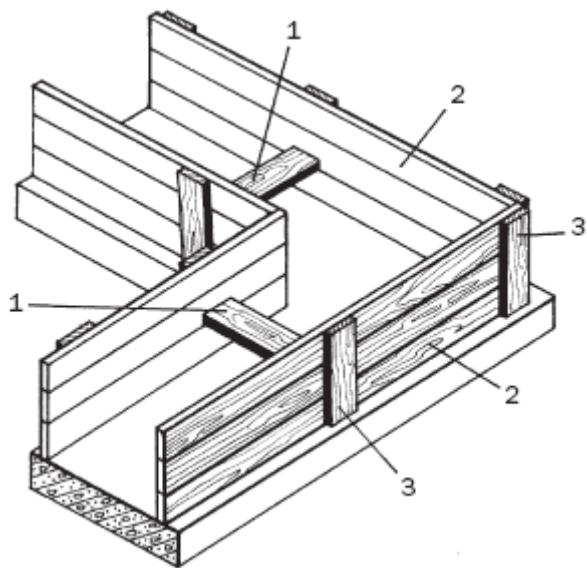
Установка опалубки: 1 - распорки; 2 - дощатые щиты; 3 - накладки
